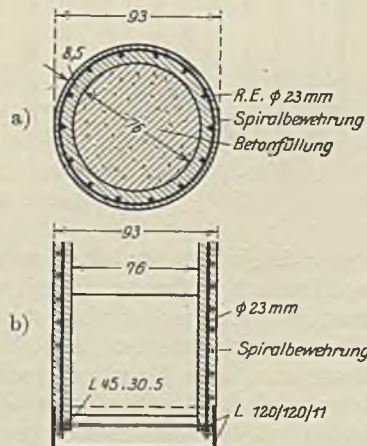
Ummantelung von Holzpfählen durch einen Eisenbetonmantel.
